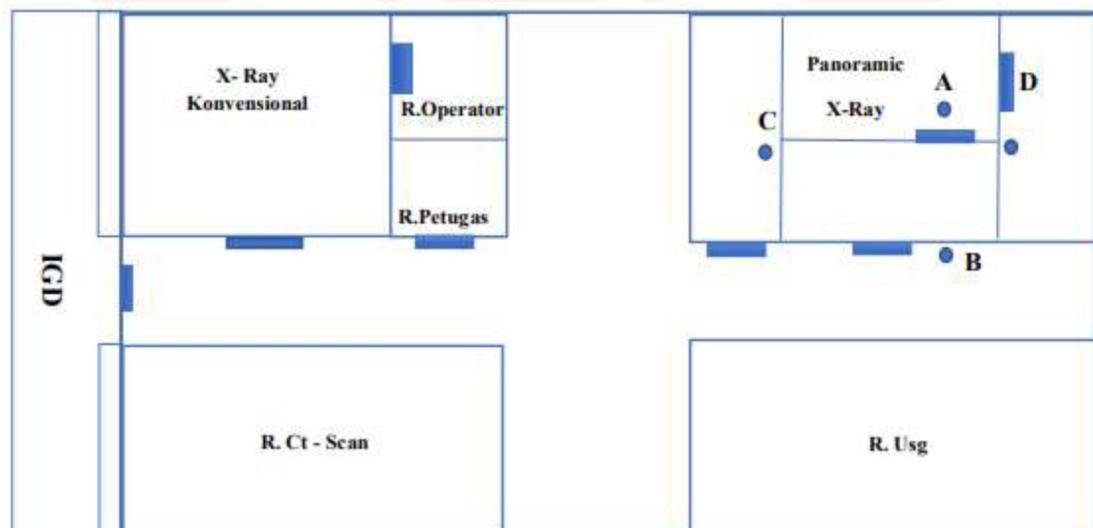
2 Denah ruang Instalasi Radiologi.
